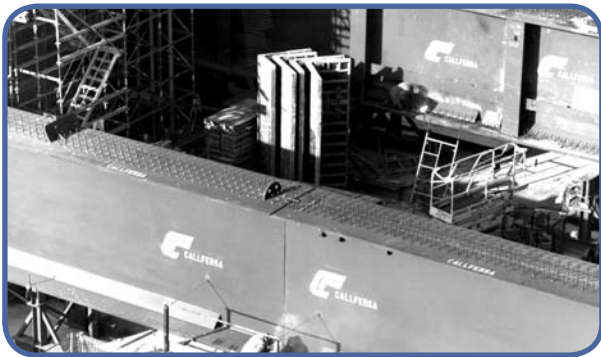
Montaje, sobre la planta baja, de las grandes vigas longitudinales, transportadas a obra desde taller por tramos
